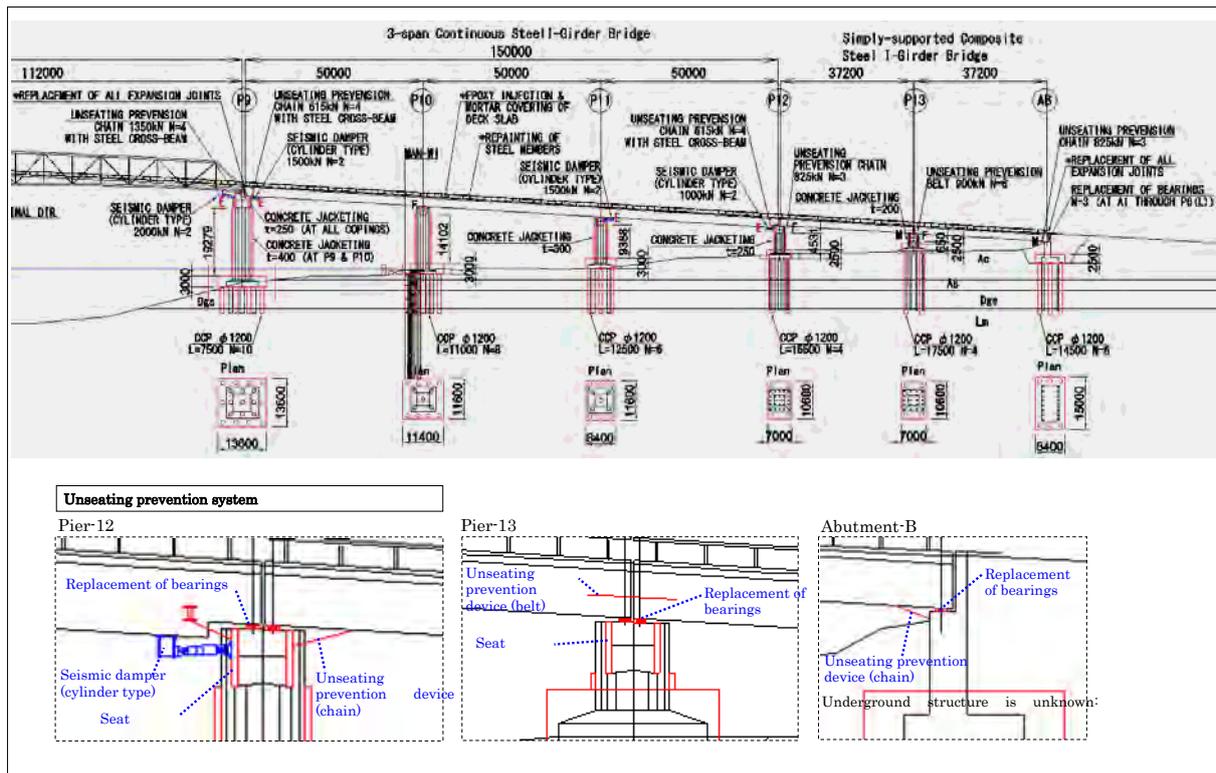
補強一般図 (1st Mandaue-Mactan Bridge 3/3)
